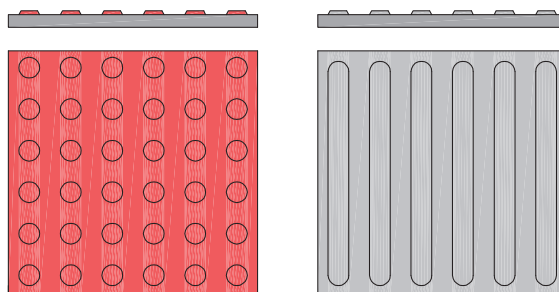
Detalle de pavimento táctil direccional y de advertencia.
